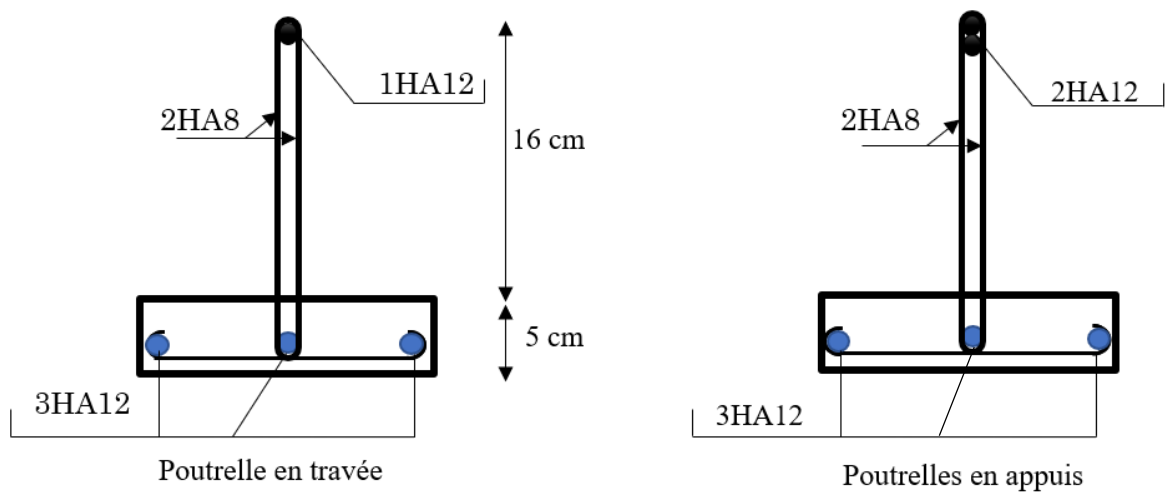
Ferrailage des poutrelles en appuis et en travée.
